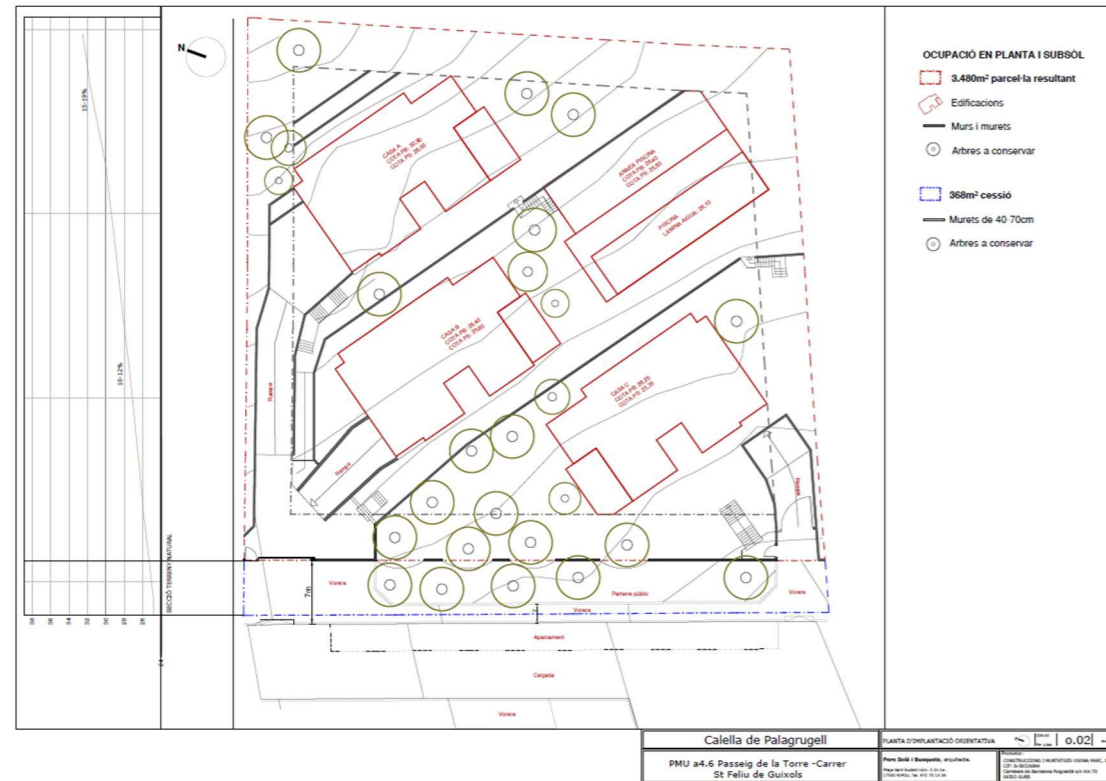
Planta d'ordenació orientativa – PMU a4.6.
